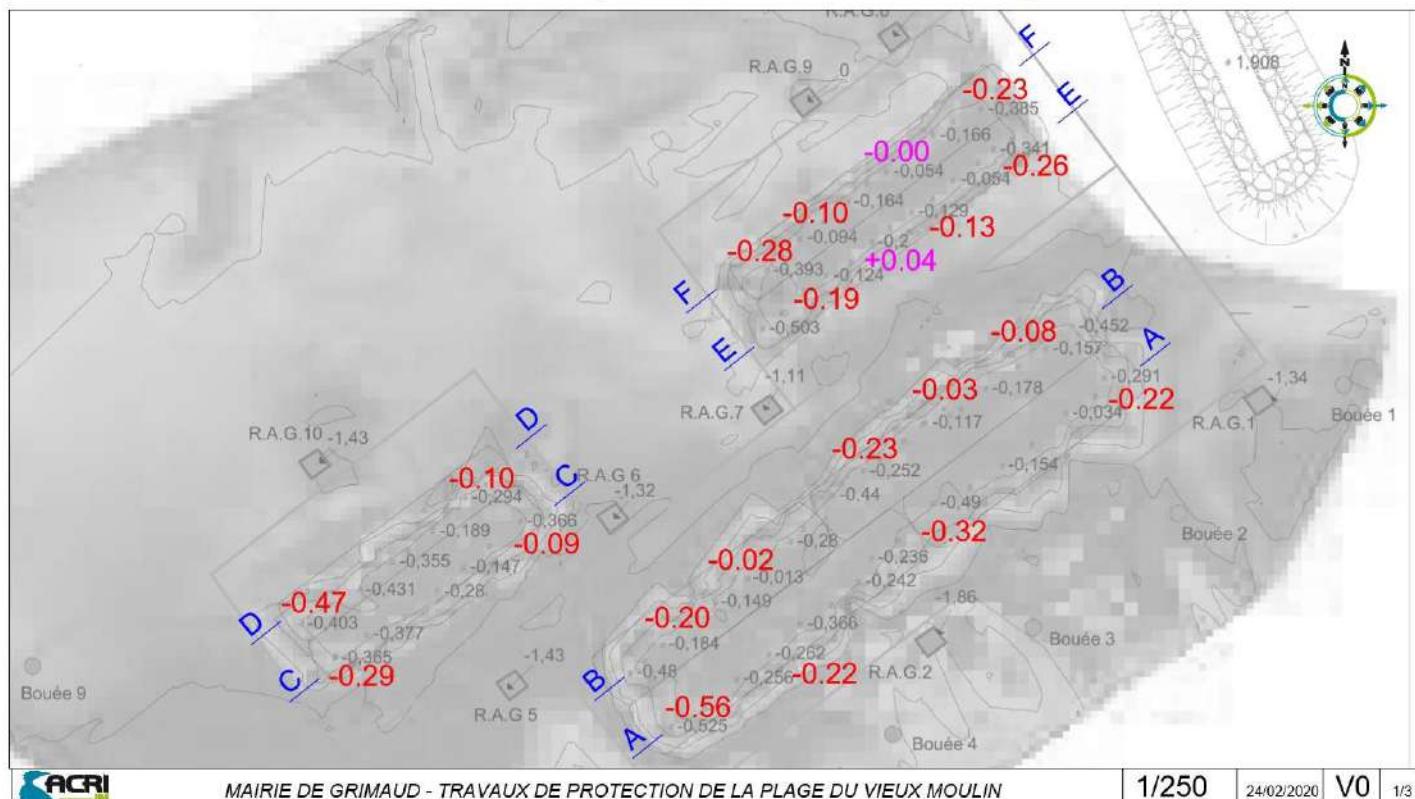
Sistemazione del tappeto antierosione in geotessuto
